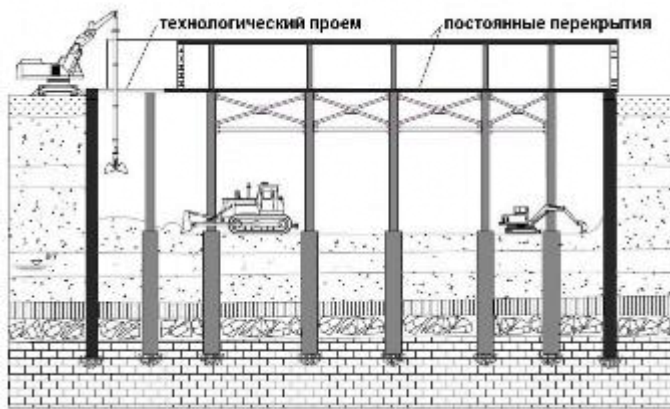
Принципова схема виконання земляних робіт в котловані під захистом влаштованого перекриття, опертого на огорожувальні стіни та паль-колони
